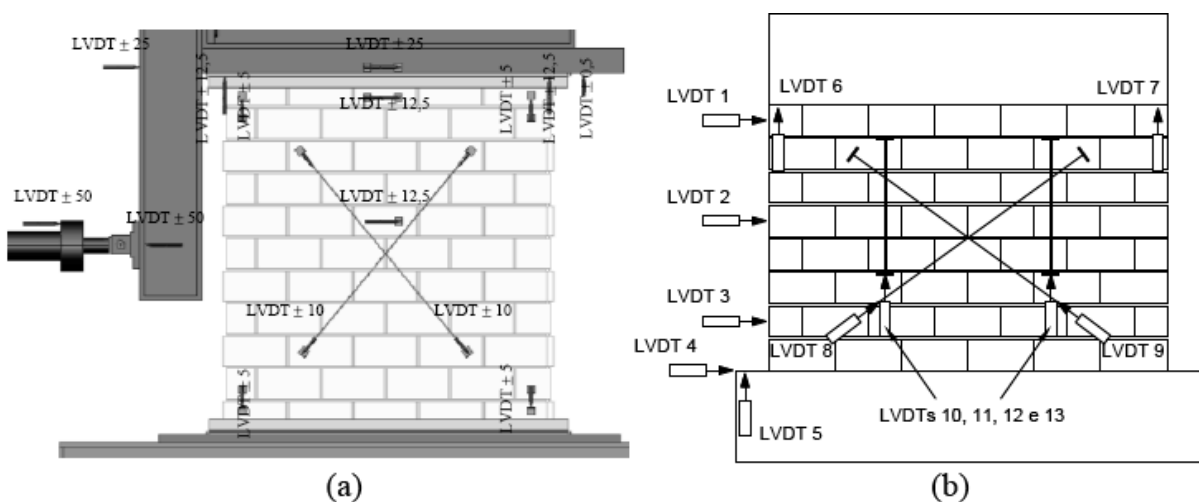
Instrumentação típica de paredes de alvenaria submetidas à ação combinada de ações verticais e horizontais: (a) Projeto Sinales; (b) Projeto Diswall (GOUVEIA, HAACH et al., 2007).
